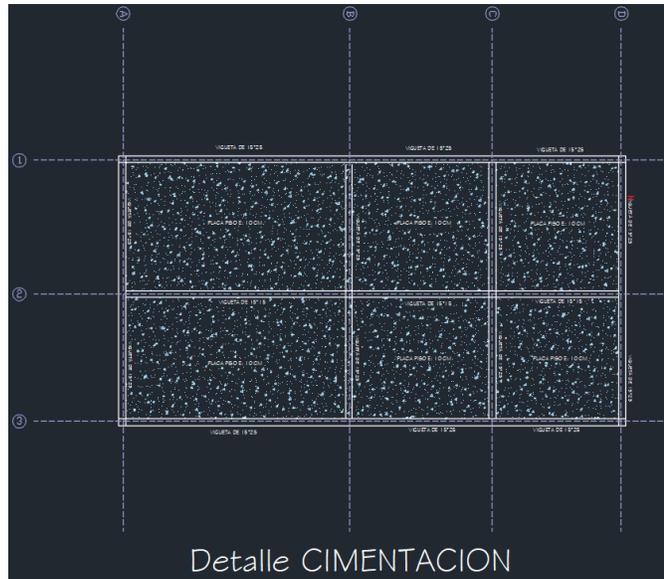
Detalle de Cimentación Casa plástico reciclado Fuente: Elaboración propia
